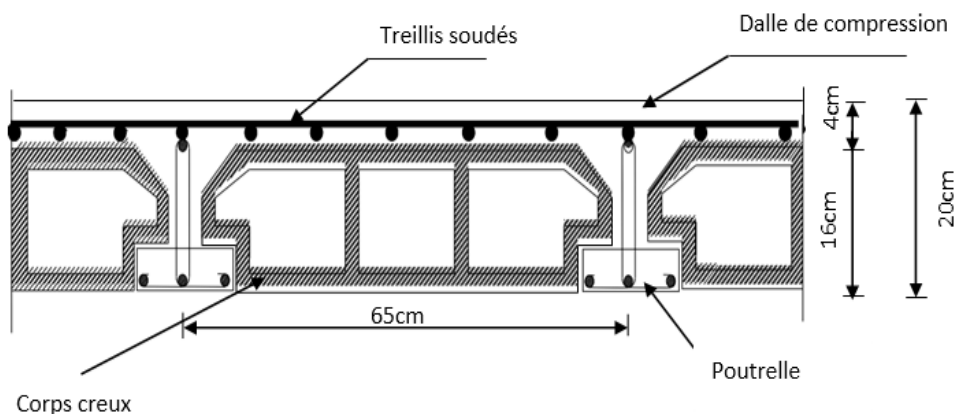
plancher en béton armé avec poutrelles
